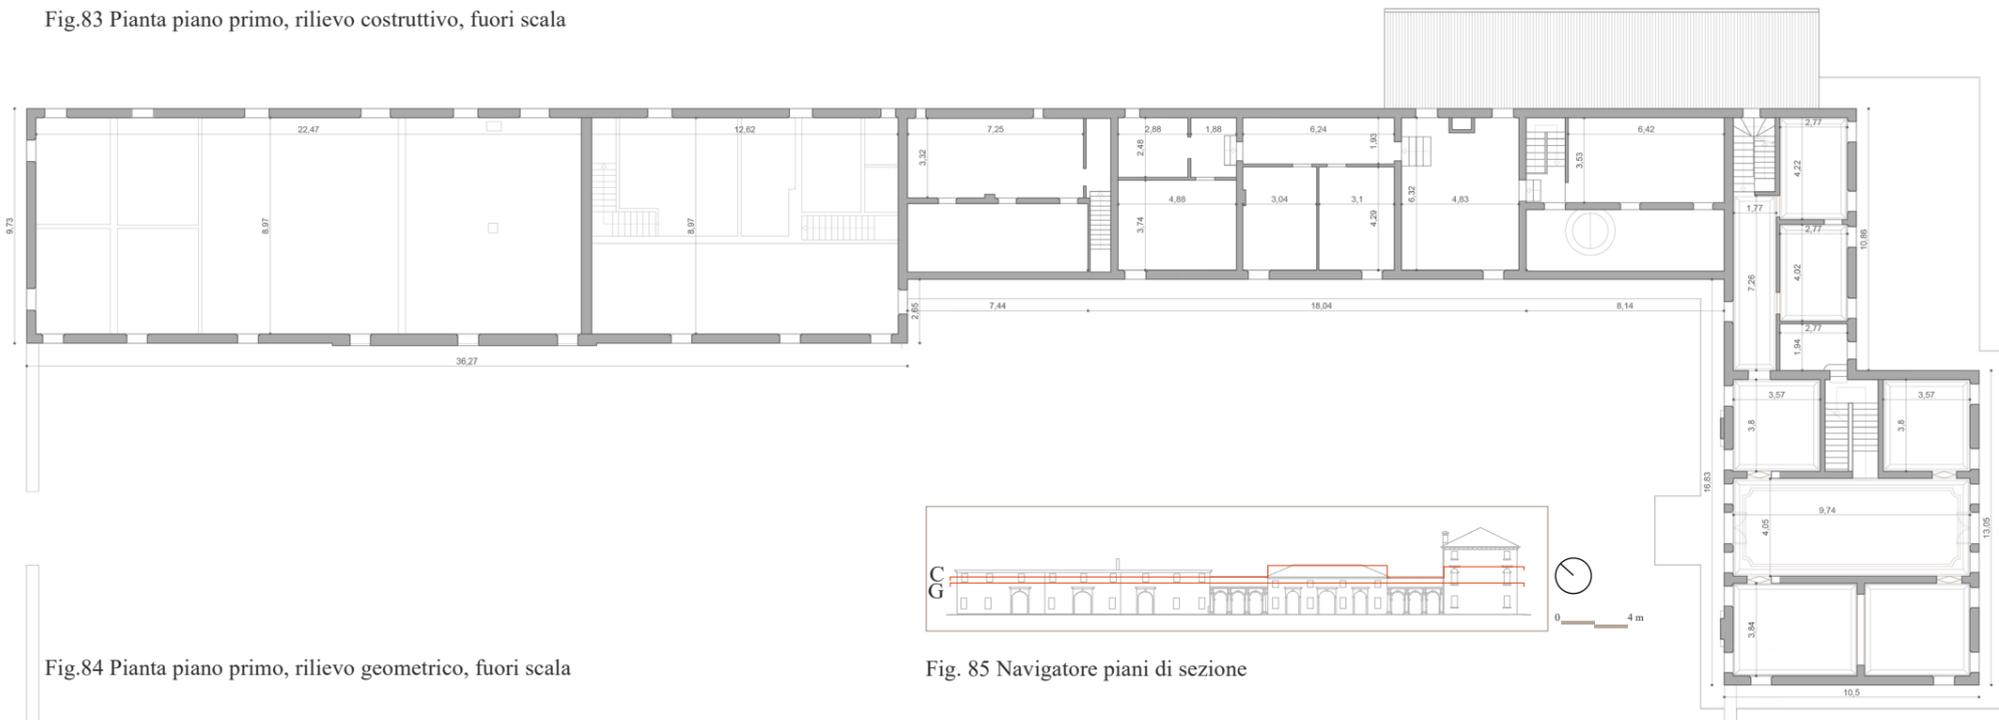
Pianta piano primo, rilievo geometrico, fuori scala
